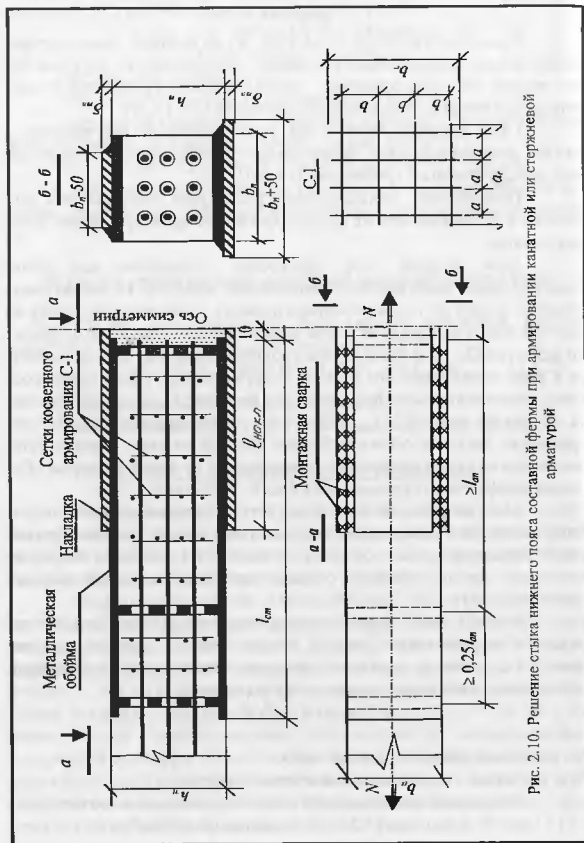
Решение стыка нижнего пояса составной фермы при армировании канатной или стержневой арматурой
